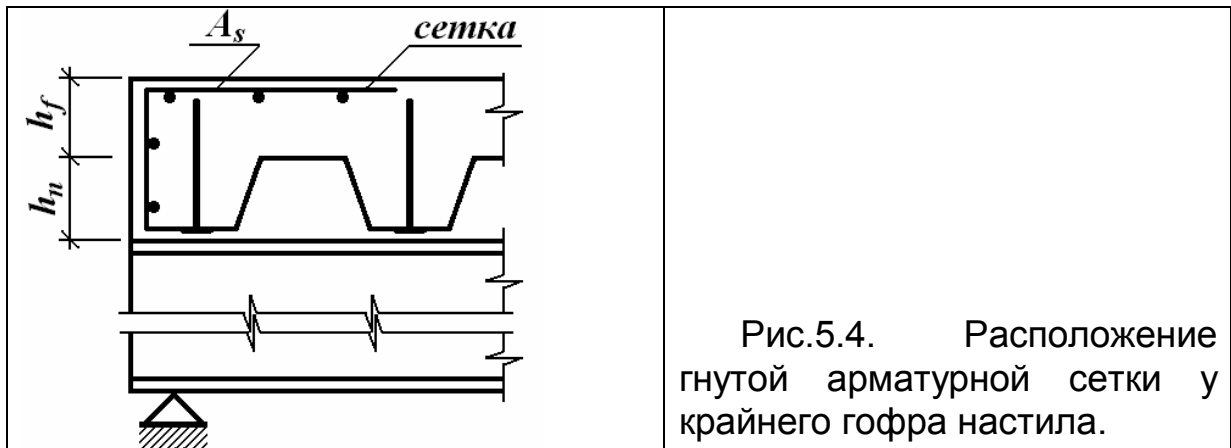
Расположение гнутой арматурной сетки у крайнего гофра настила.
